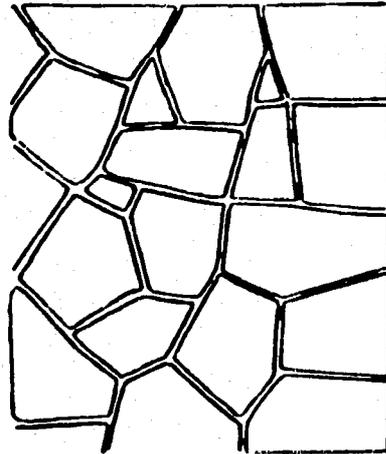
En la mampostería concertada los mampuestos están ligeramente labrados
